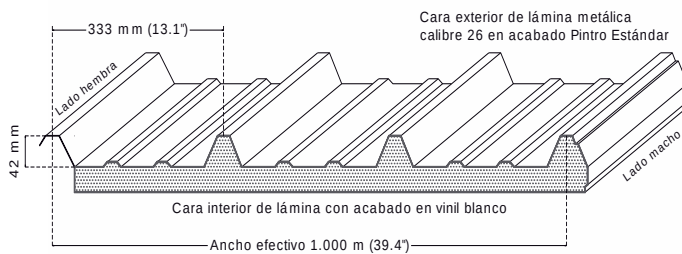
Sección de cubierta tipo sándwich. Elaboración propia
